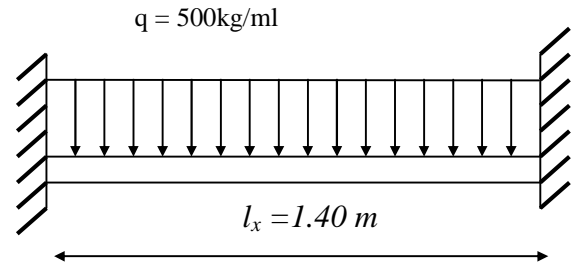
Schéma statique de la dalle sur quatre appuis
